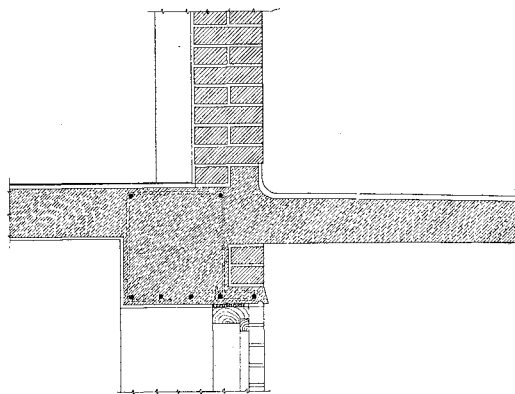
Vinduesbjælke af Jernbeton med Altan og Dæk af Jernbeton. Den synlige Bæreknaest af Jernbeton støbes med Façadesiden i glat Form. Skalmuringen udføres efter Afformningen.
